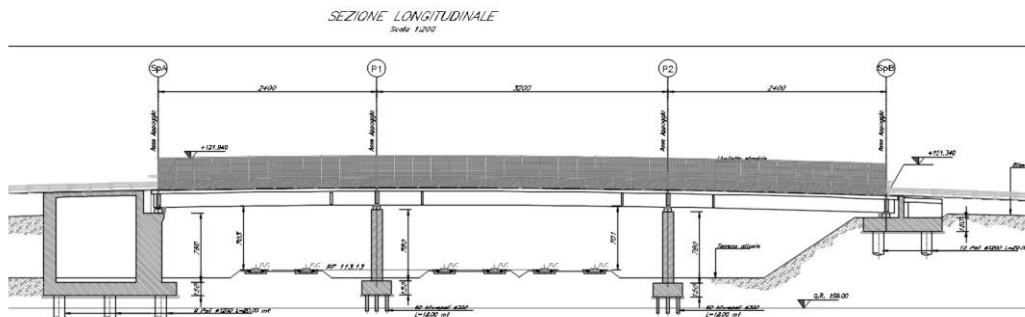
Sezione longitudinale nuovo cavalcaferrovia S.R.10
